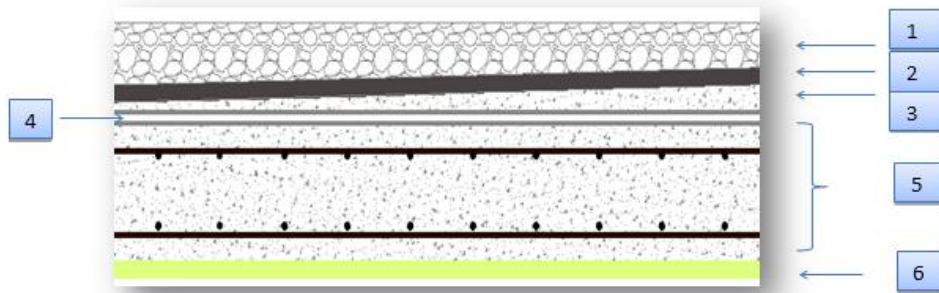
Composants d'un plancher terrasse en dalle pleine.
